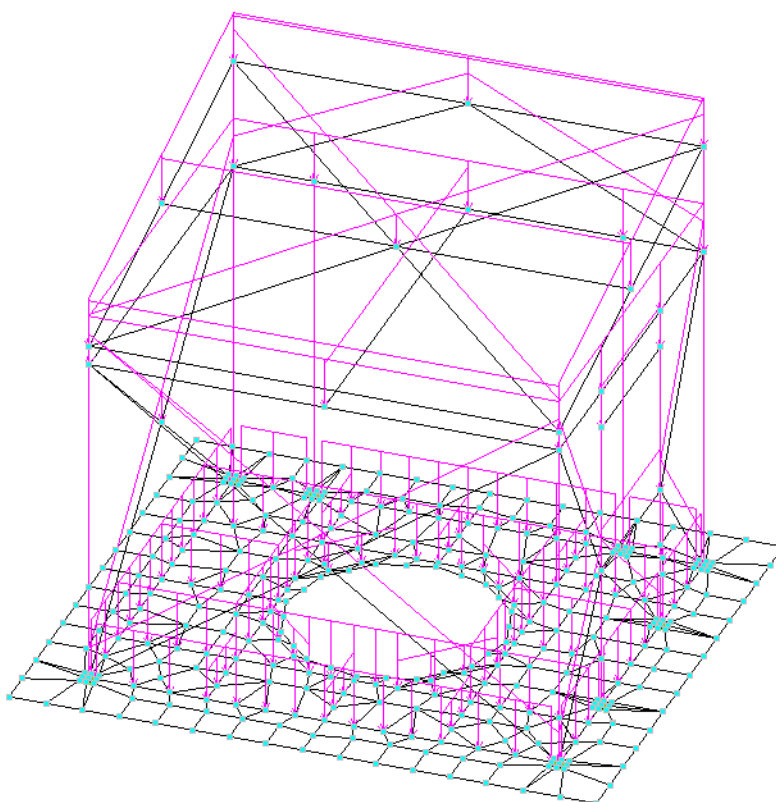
Общий вид загрузки от веса элементов расчетной схемы (стального каркаса)
